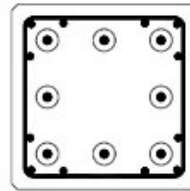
Dettaglio della sezione del pilastro BAUTEC e sezioni correlate.
